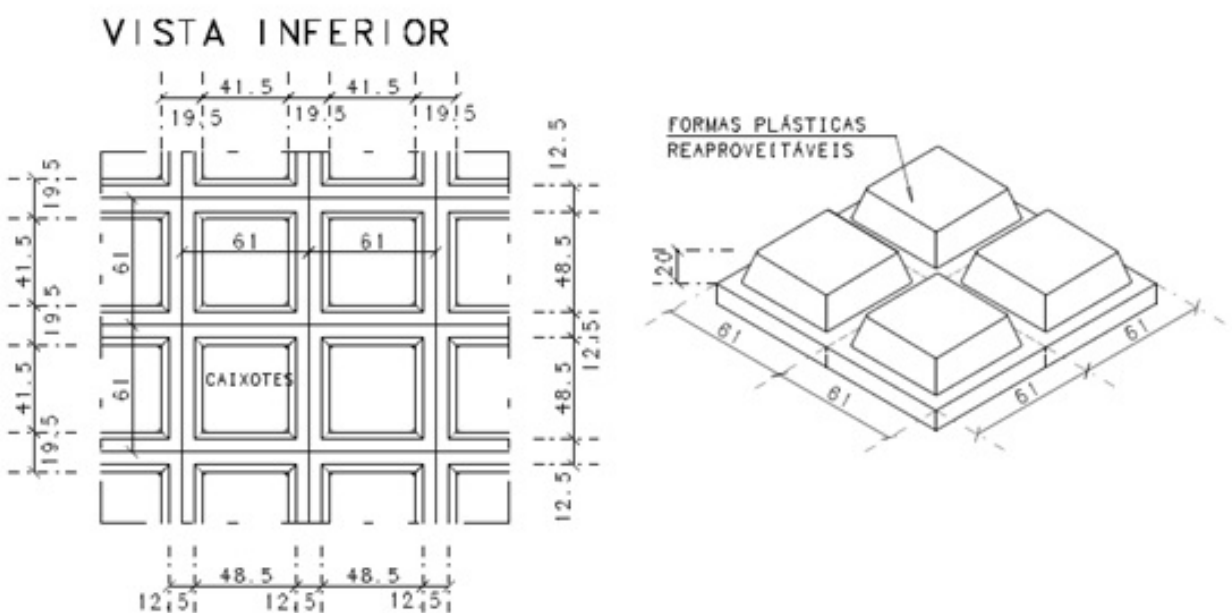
Detalhe típico da laje nervurada tipo PavPlus
